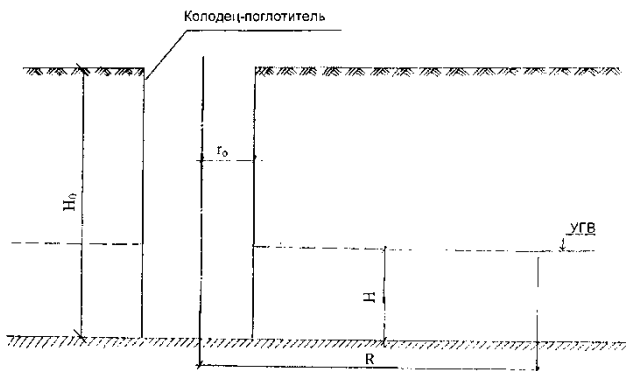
Расчетная схема колодца-поглотителя для сброса воды в водоносный слой
